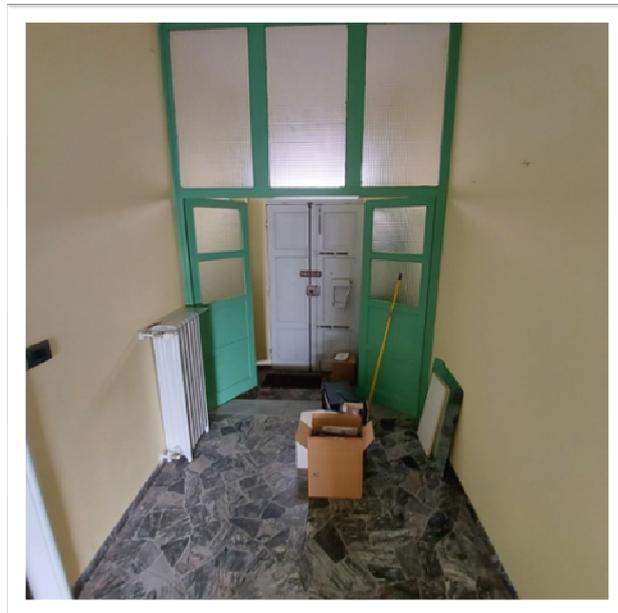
PT Ingresso (part. portoncino dall'interno)
